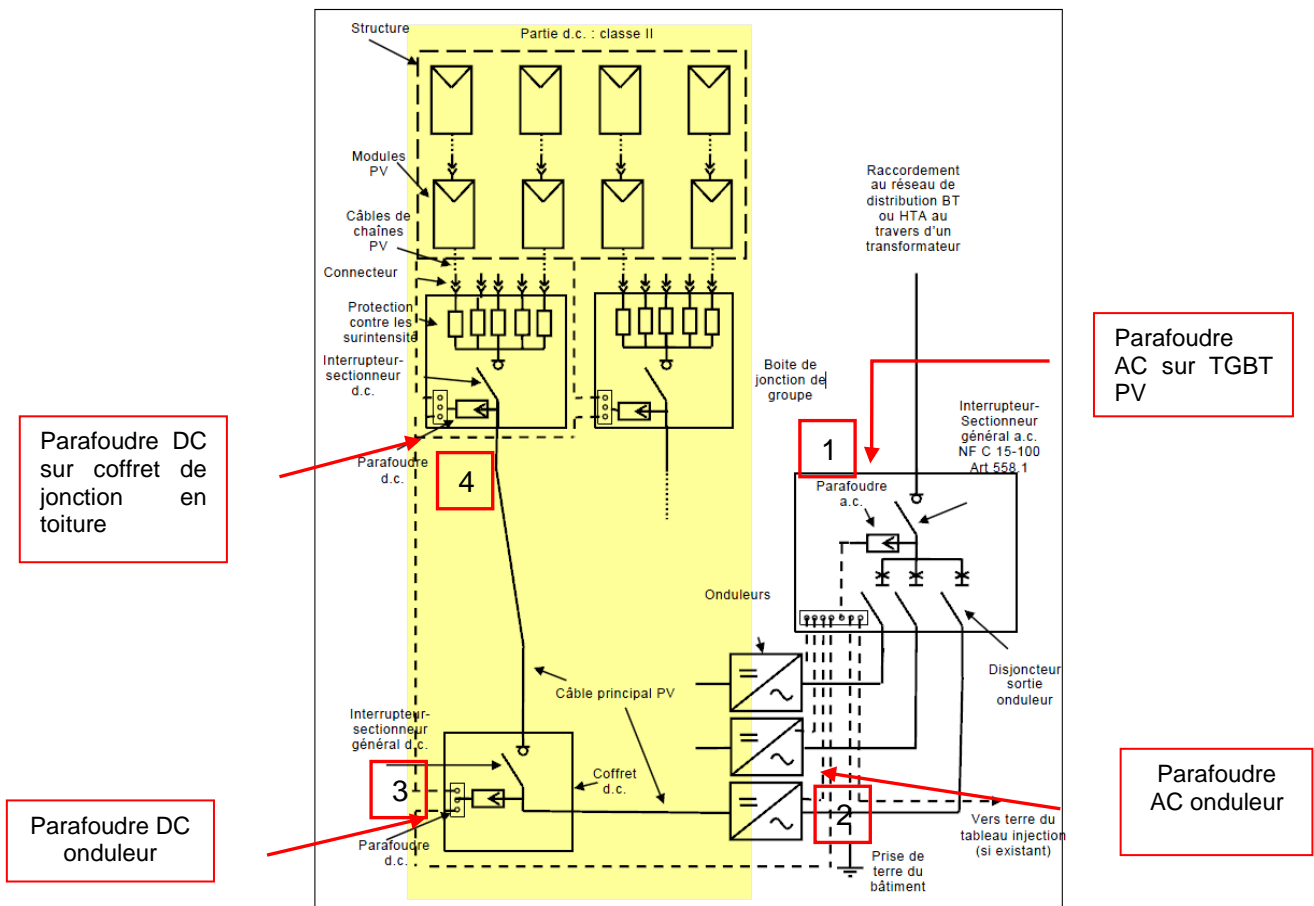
Implantation des parafoudres sur l'installation PV. (UTE 15-712)
